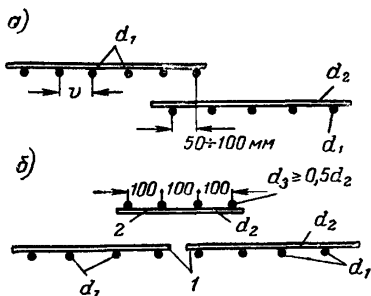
Стыки сварных сеток в нерабочем направлении
